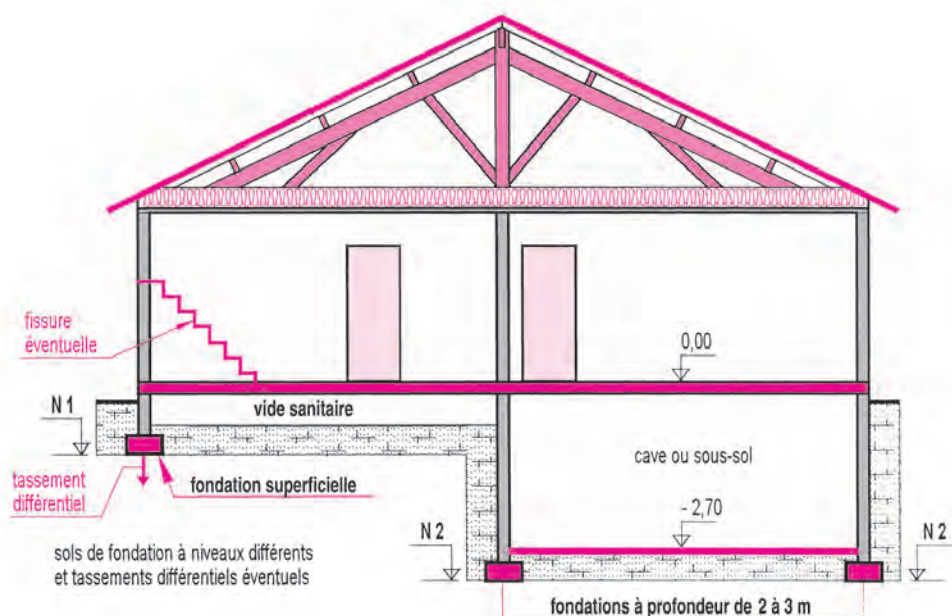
Cas d'un vide sanitaire et d'un sous-sol
